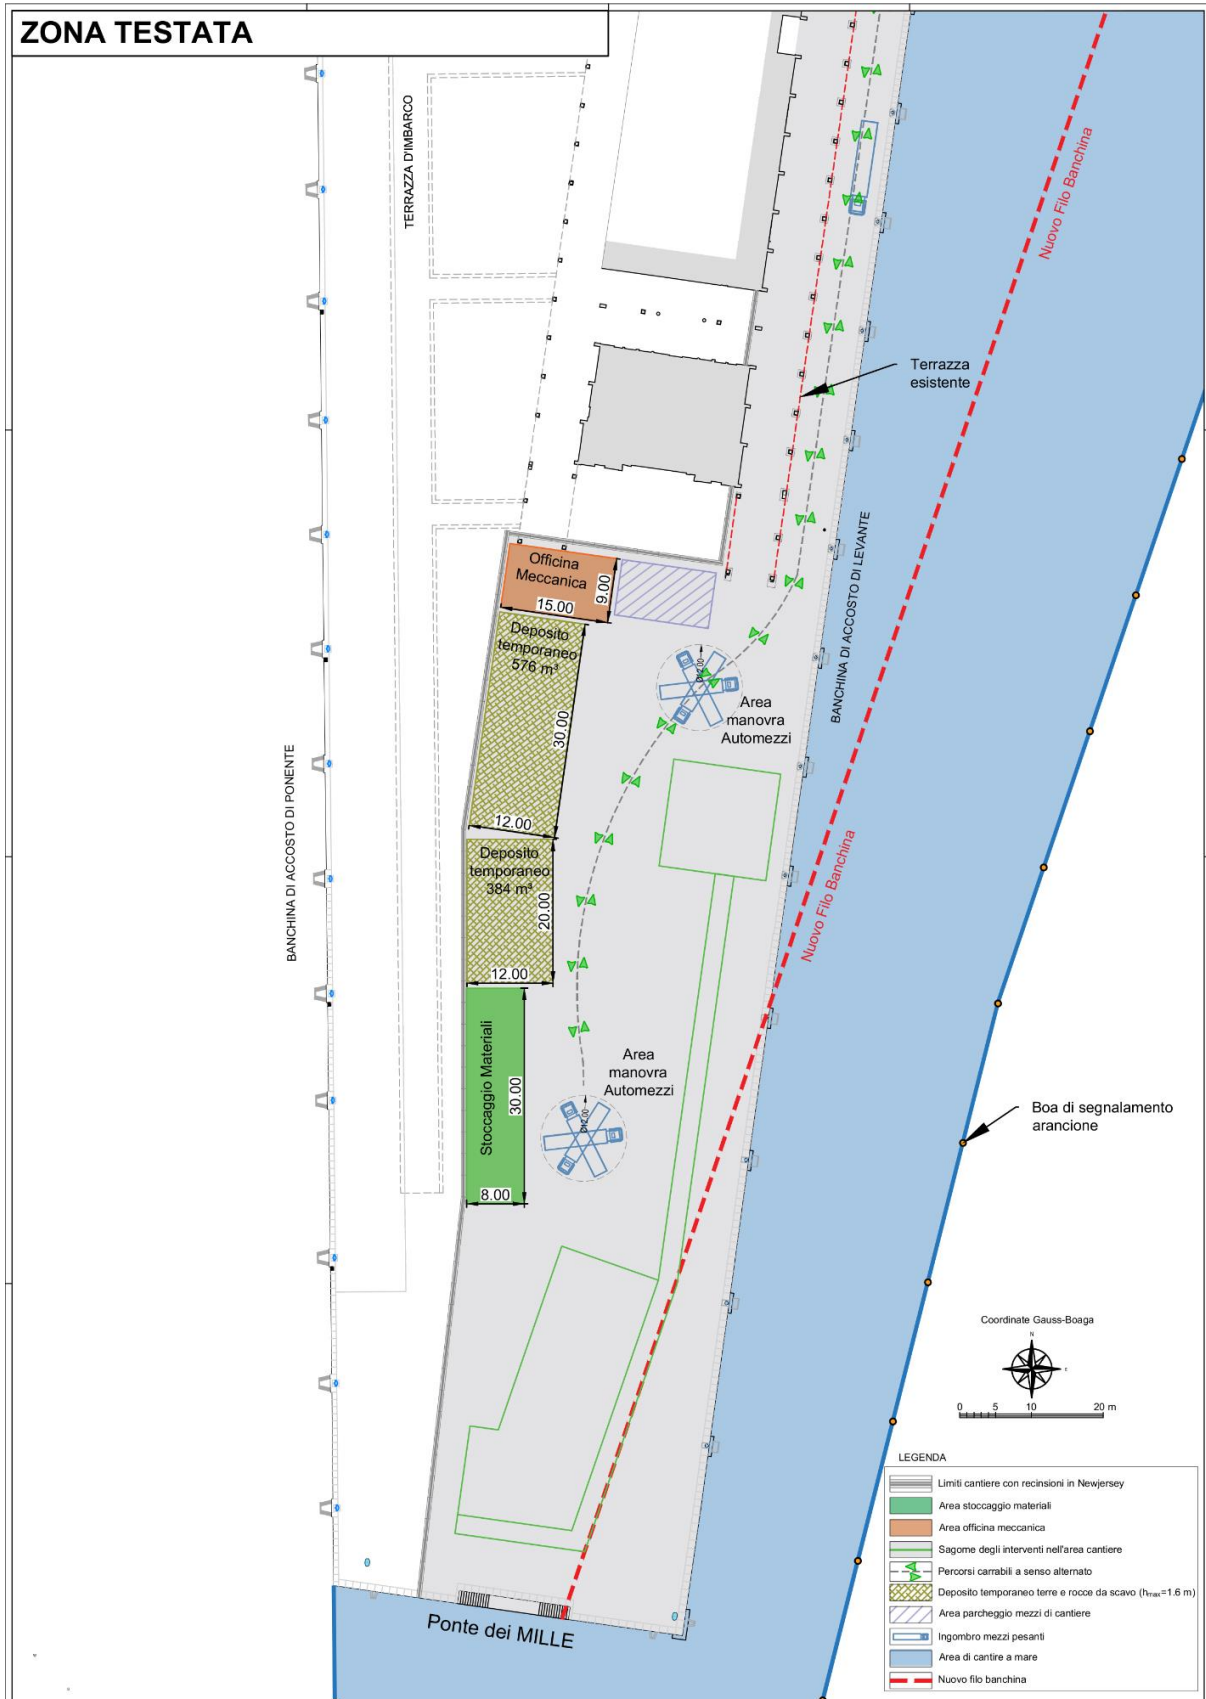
Dettaglio area testata pontile - Planimetria del layout generale di cantiere
